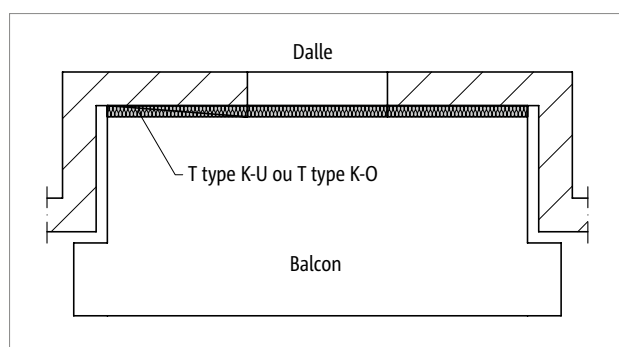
Schöck Isokorb® T types K-U/K-O : balcon dans le cas d'un retrait de façade
